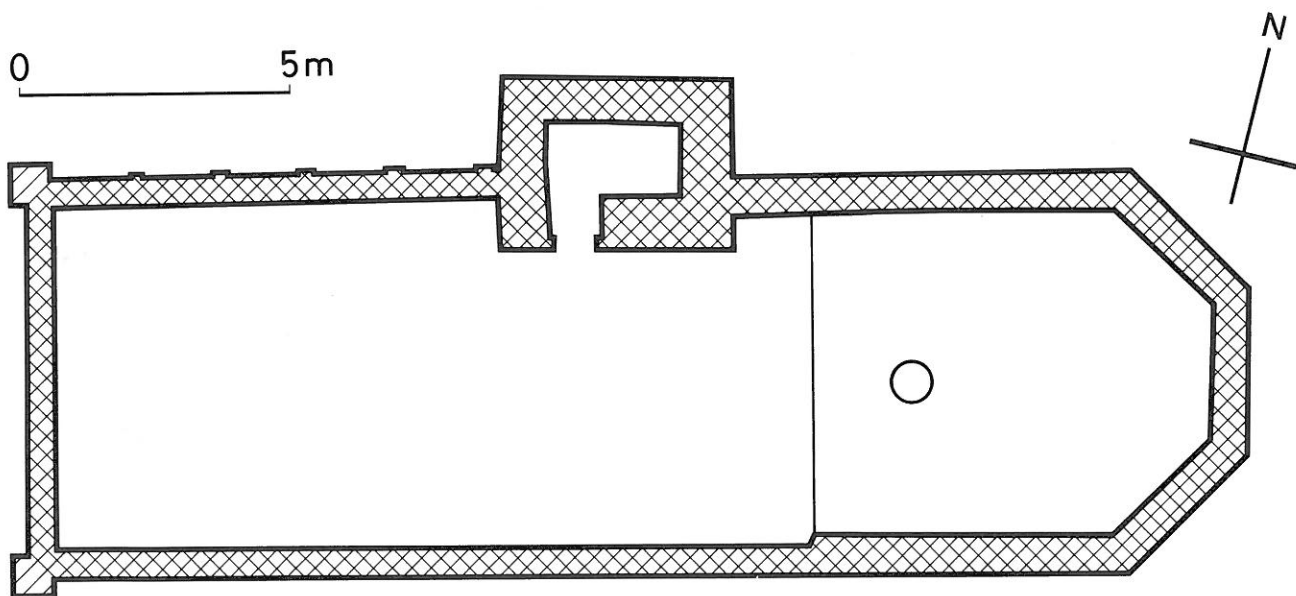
Grundriss der Anlage VII. M. 1:140
